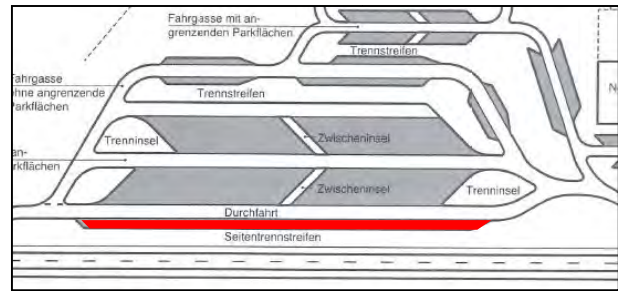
typischer Aufbau der Lkw-Parkstände einer Rastanlage (rot dargestellt - Längsparkstände) nach ERS (FGSV 2011)
